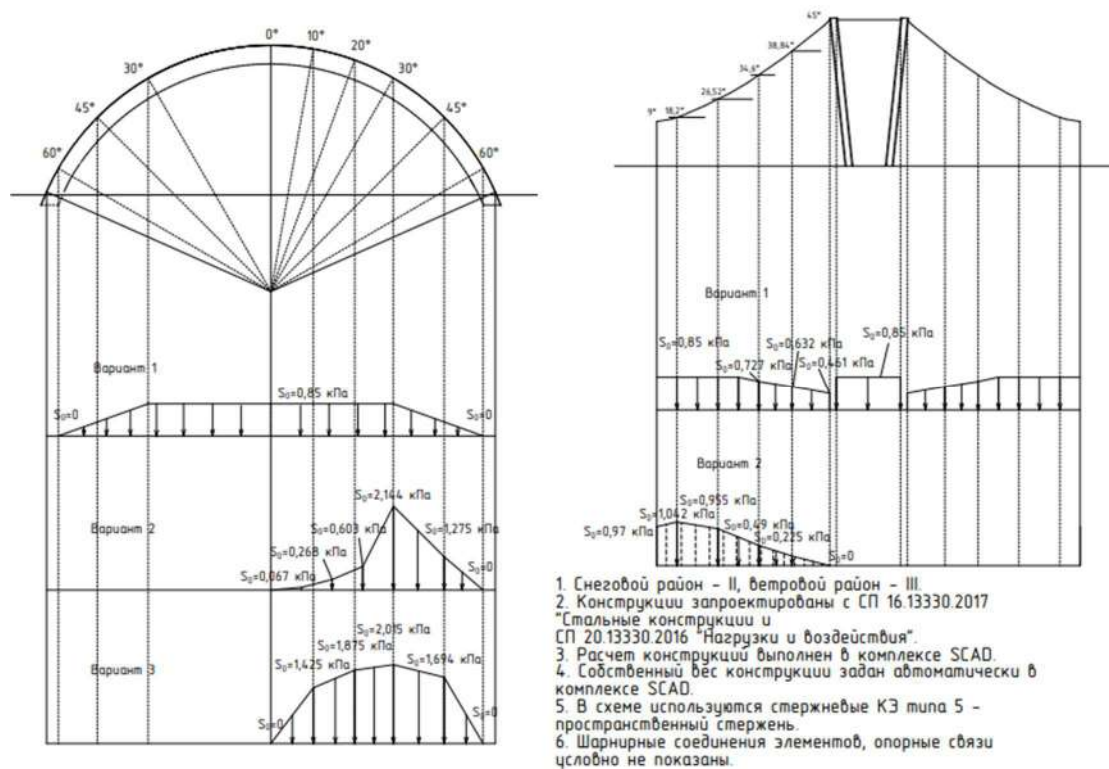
Схема загрузки снеговой нагрузки на покрытие здания.
